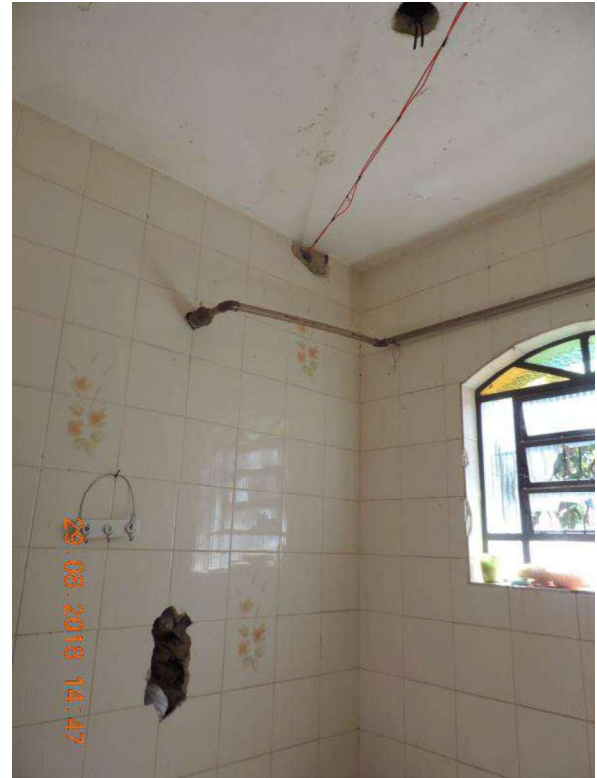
VISTA INTERNA DA “ÁREA DA CHURRASQUEIRA”
